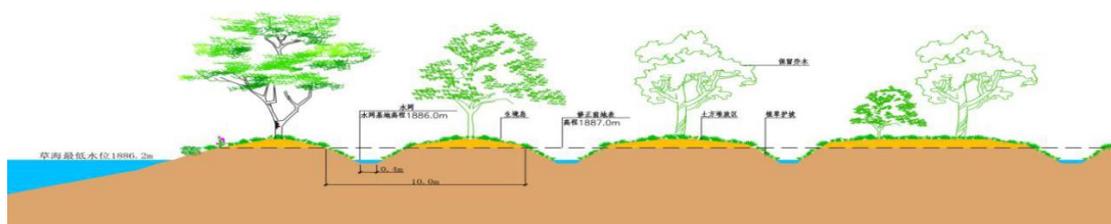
B 地块微地形改造设计淹没水域断面图
